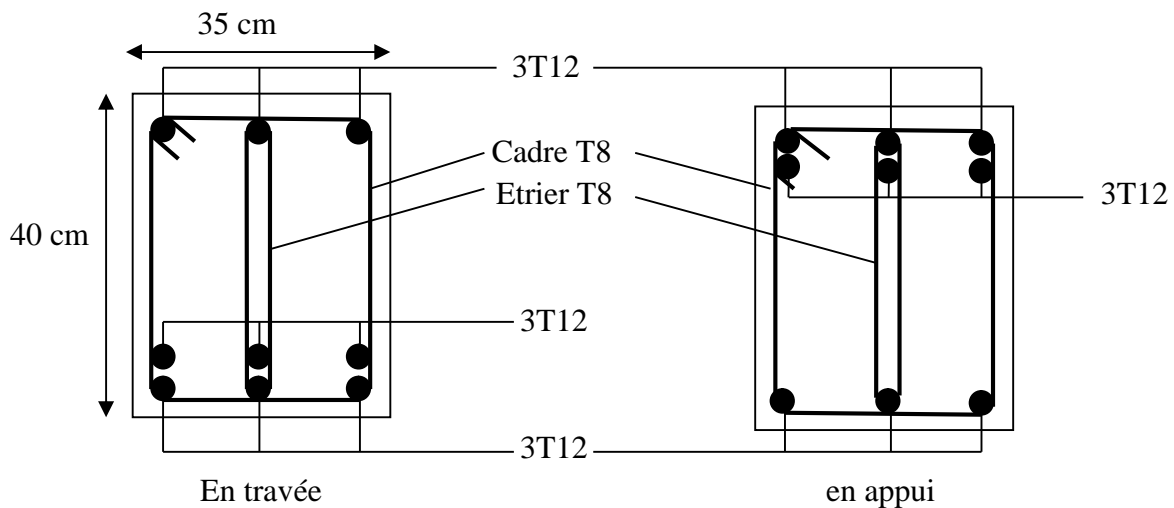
Schéma de ferrailage de la poutre principale des étages
